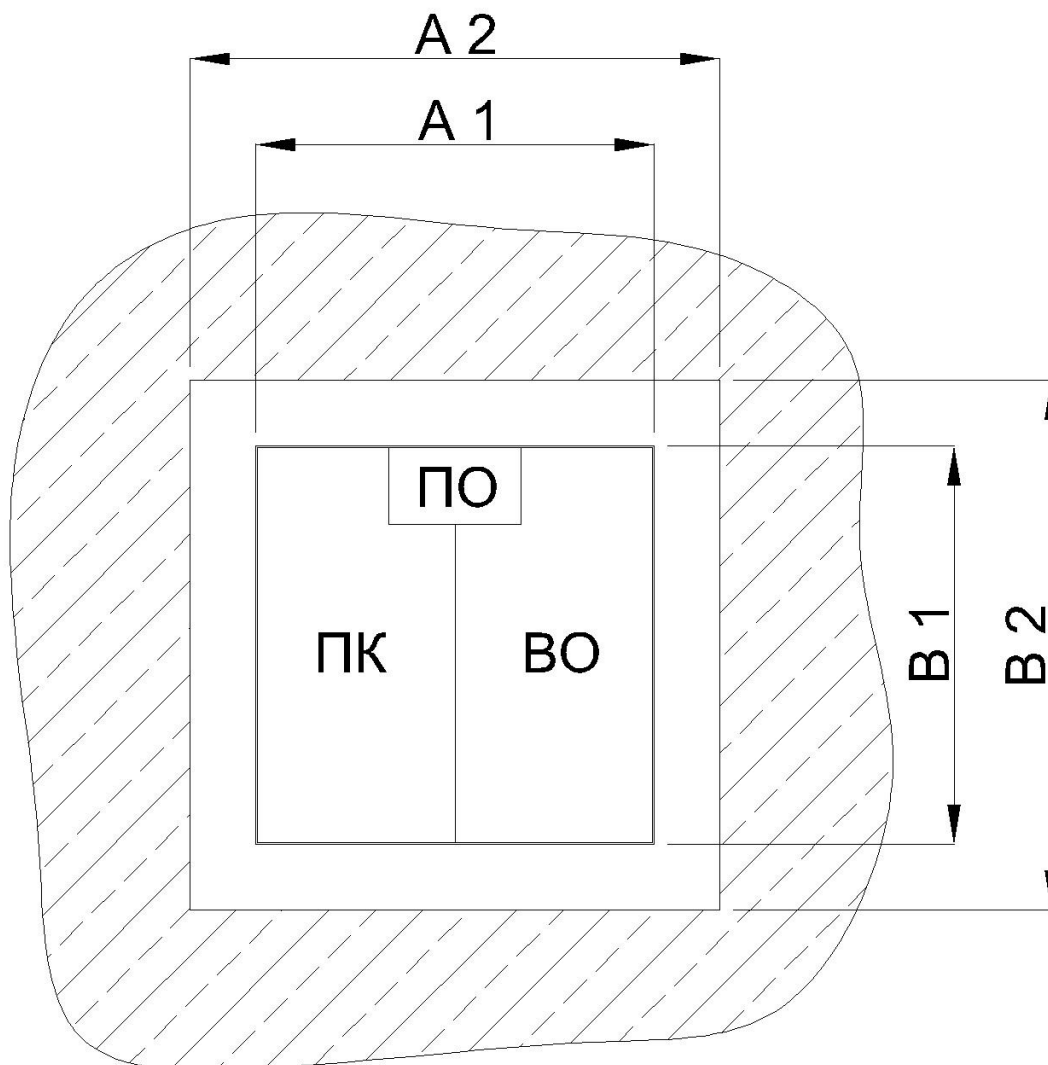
Обозначение габаритных размеров станции «ЕВРОБИОН» в разрезе (вид с боку).
